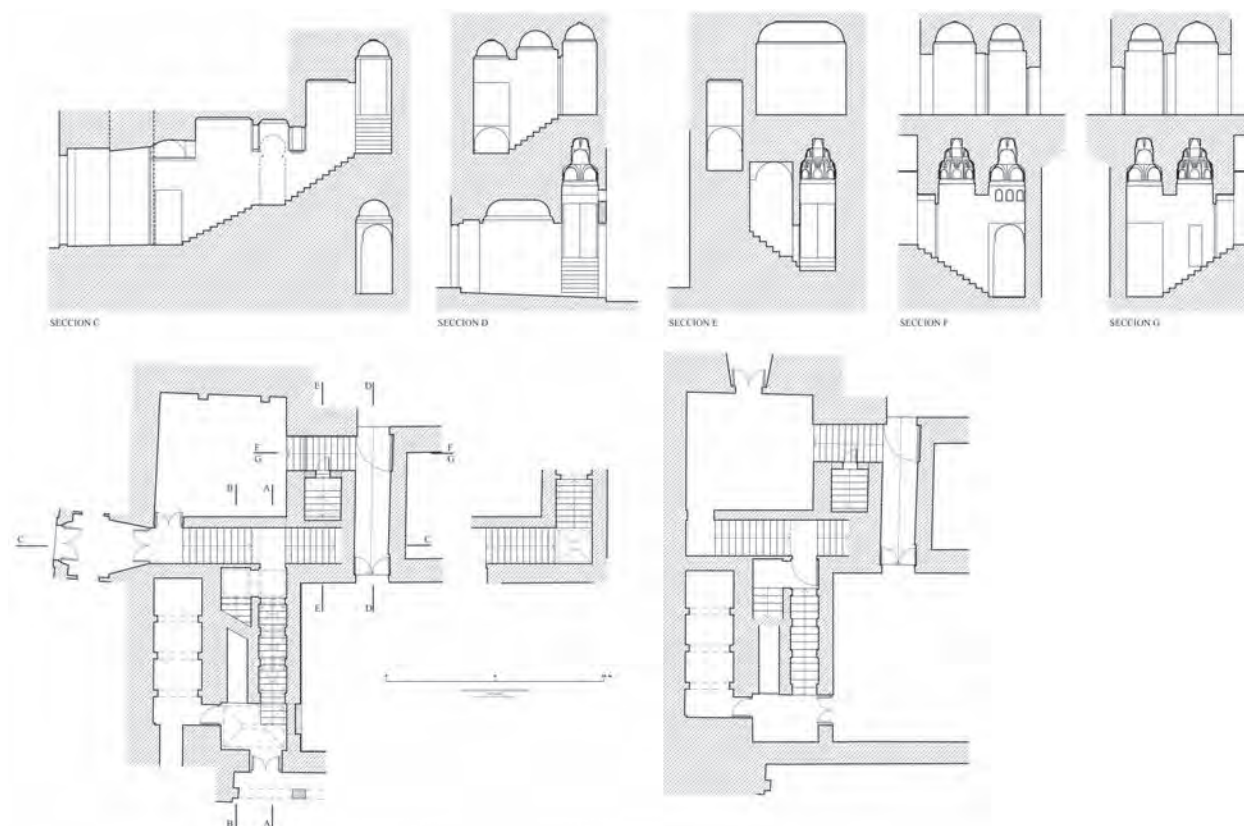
Plantas y secciones de la escalera privada. La planta de la derecha corresponde al estado original. En ambas plantas aparecen representadas las dos escaleras, pública y privada (A. Almagro).
